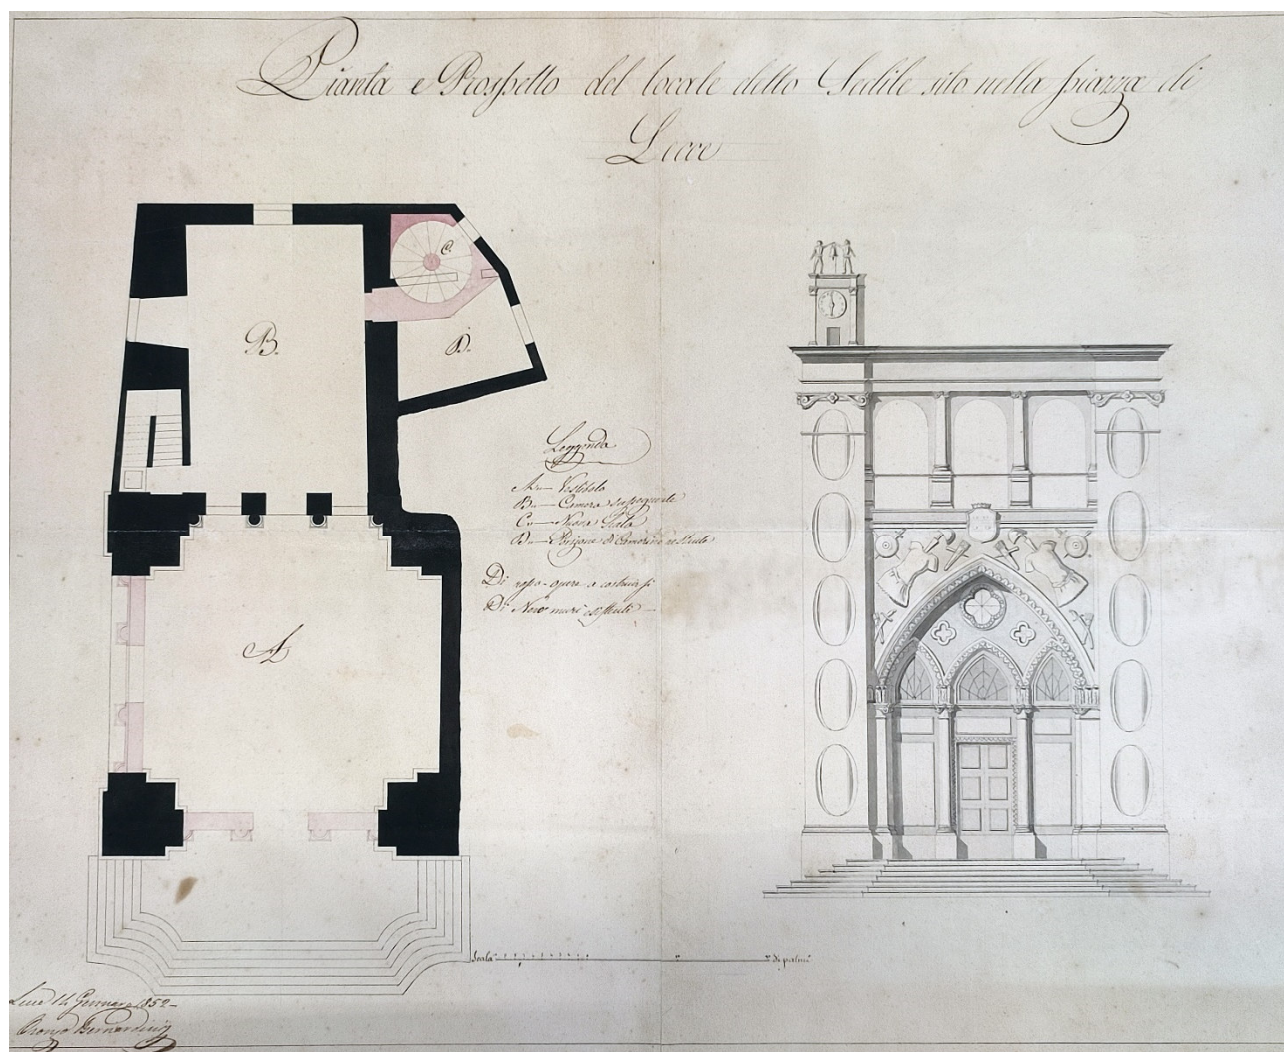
Pianta e prospetto del locale del Sedile di Lecce, 1852. Legenda: A_Vestibolo, B_Camera susseguente, C_Nuova scala, D_Porzione di Camerino restante, Di rosso - opere a costruirsi, Di nero - muri esistenti (ASL, Int. Aff. Part.ri).
